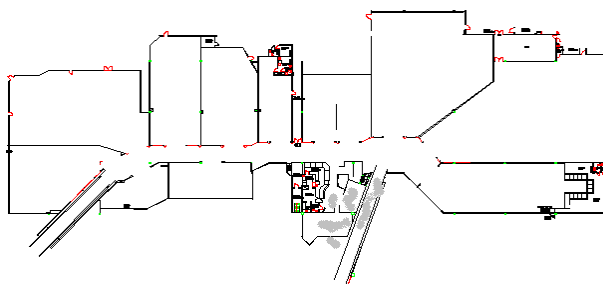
Tid till brandgasfyllnad av övre plan vid brand opåverkad av sprinkler.
